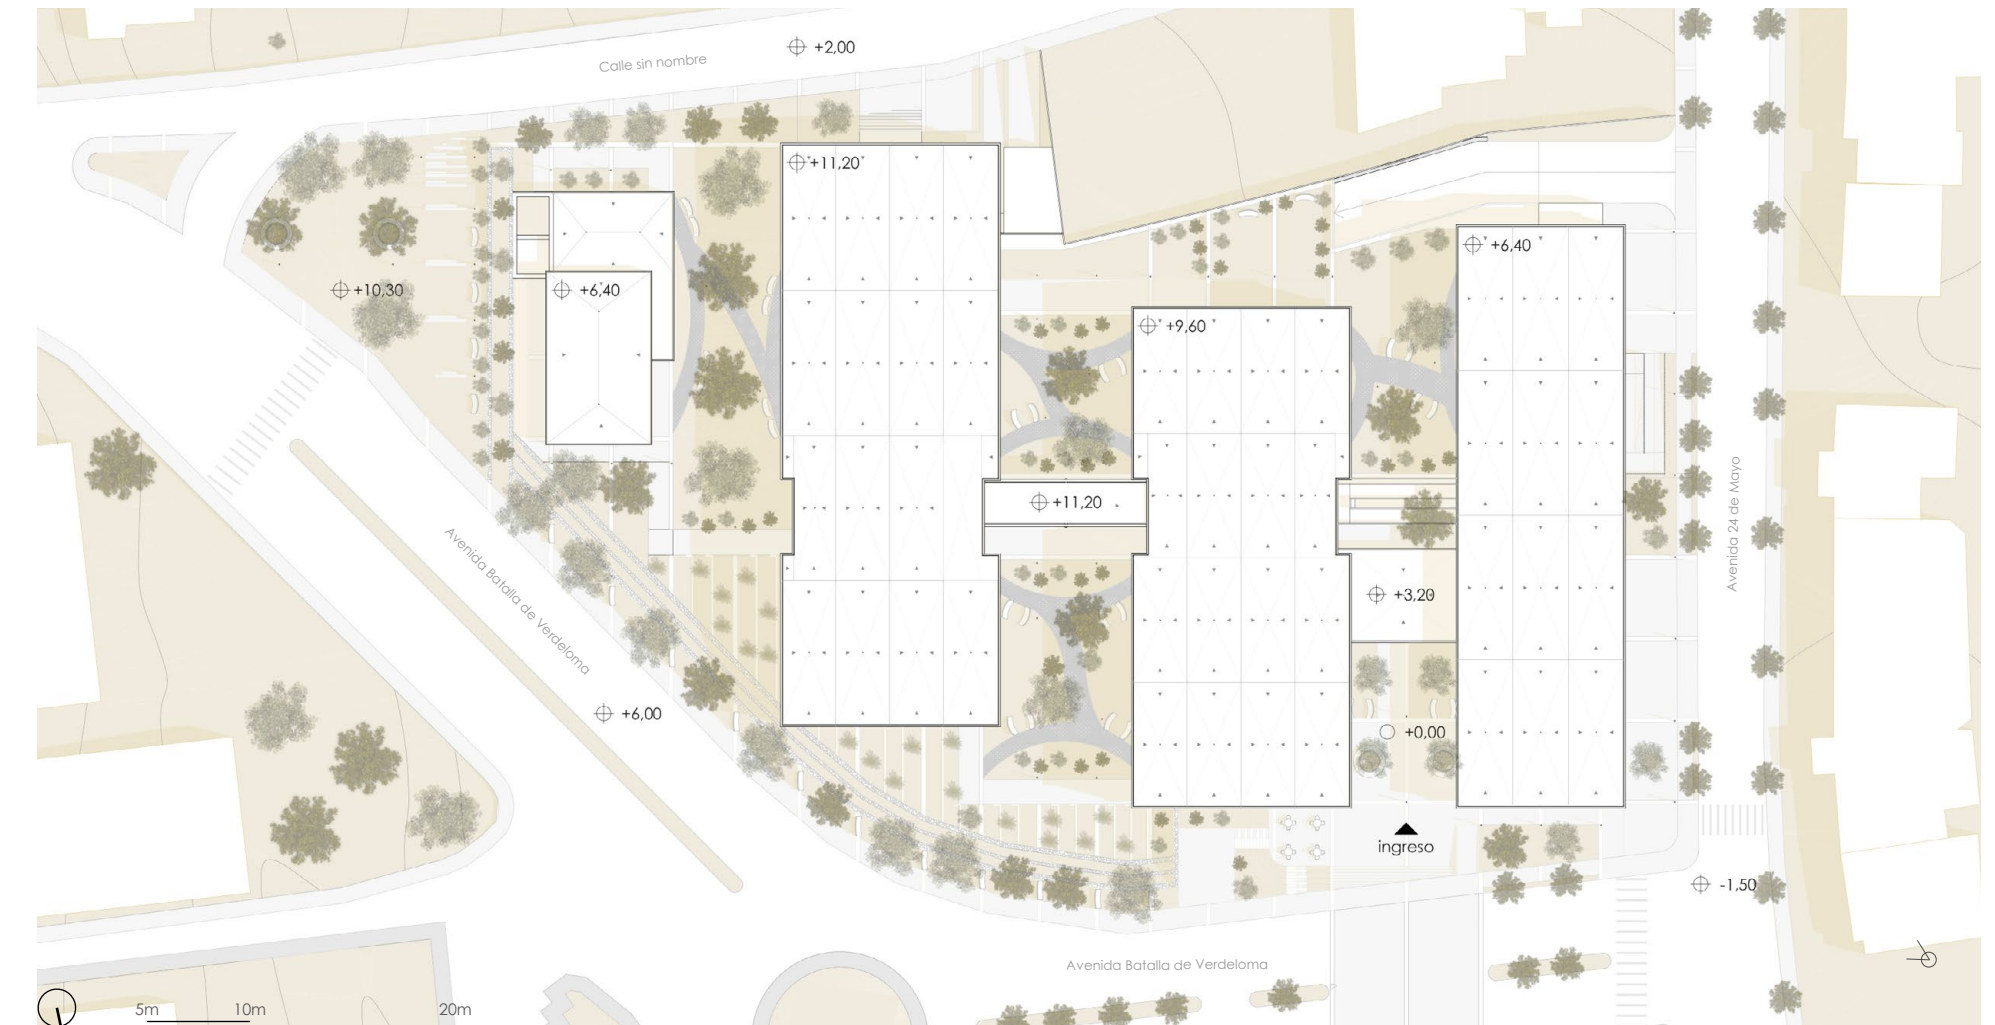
Planta Cubiertas. Fuente: Autoría propia.
